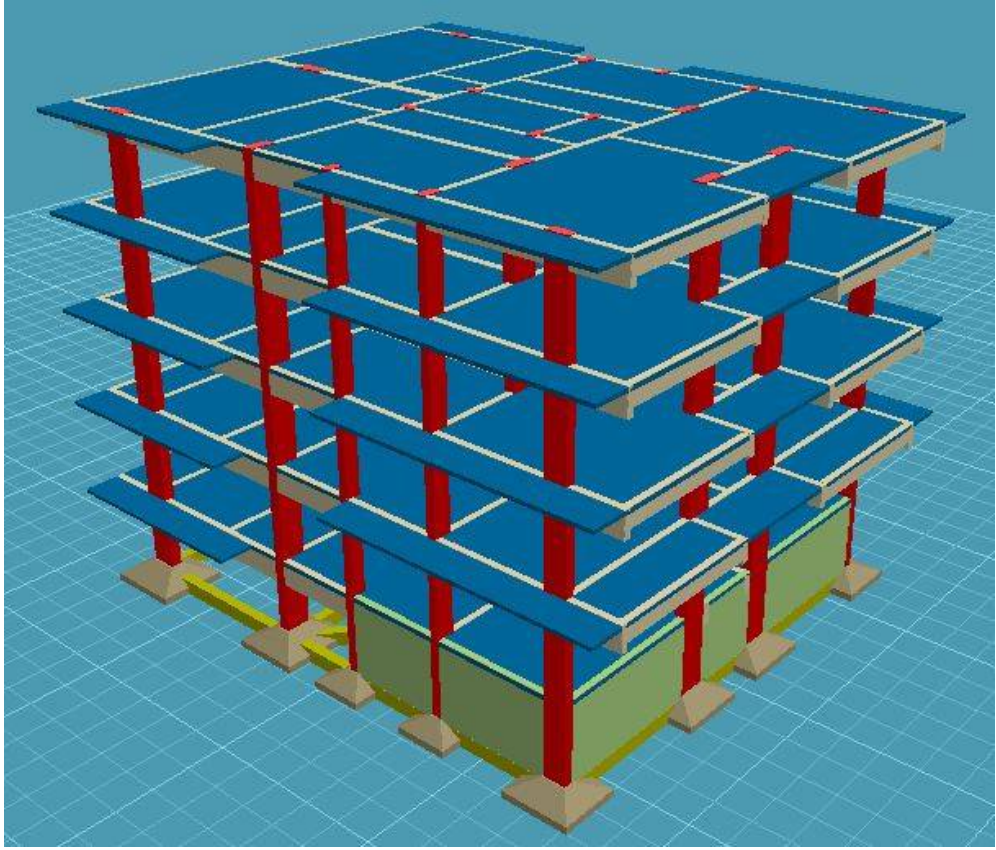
(15) Nolu bina modelleme kat planı
